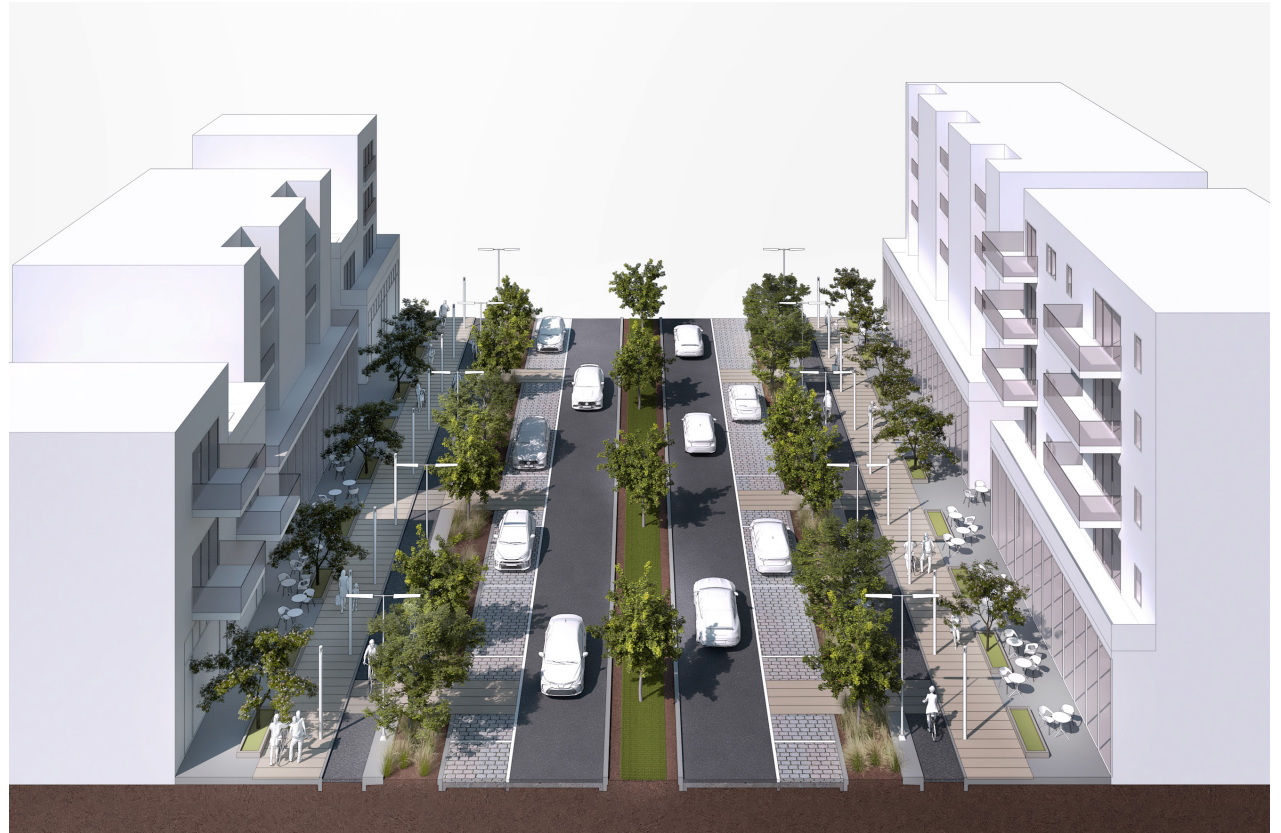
Proposition de réaménagement du boulevard Harwood, advenant la construction de la voie de contournement de l'autoroute du Souvenir (A-20)
